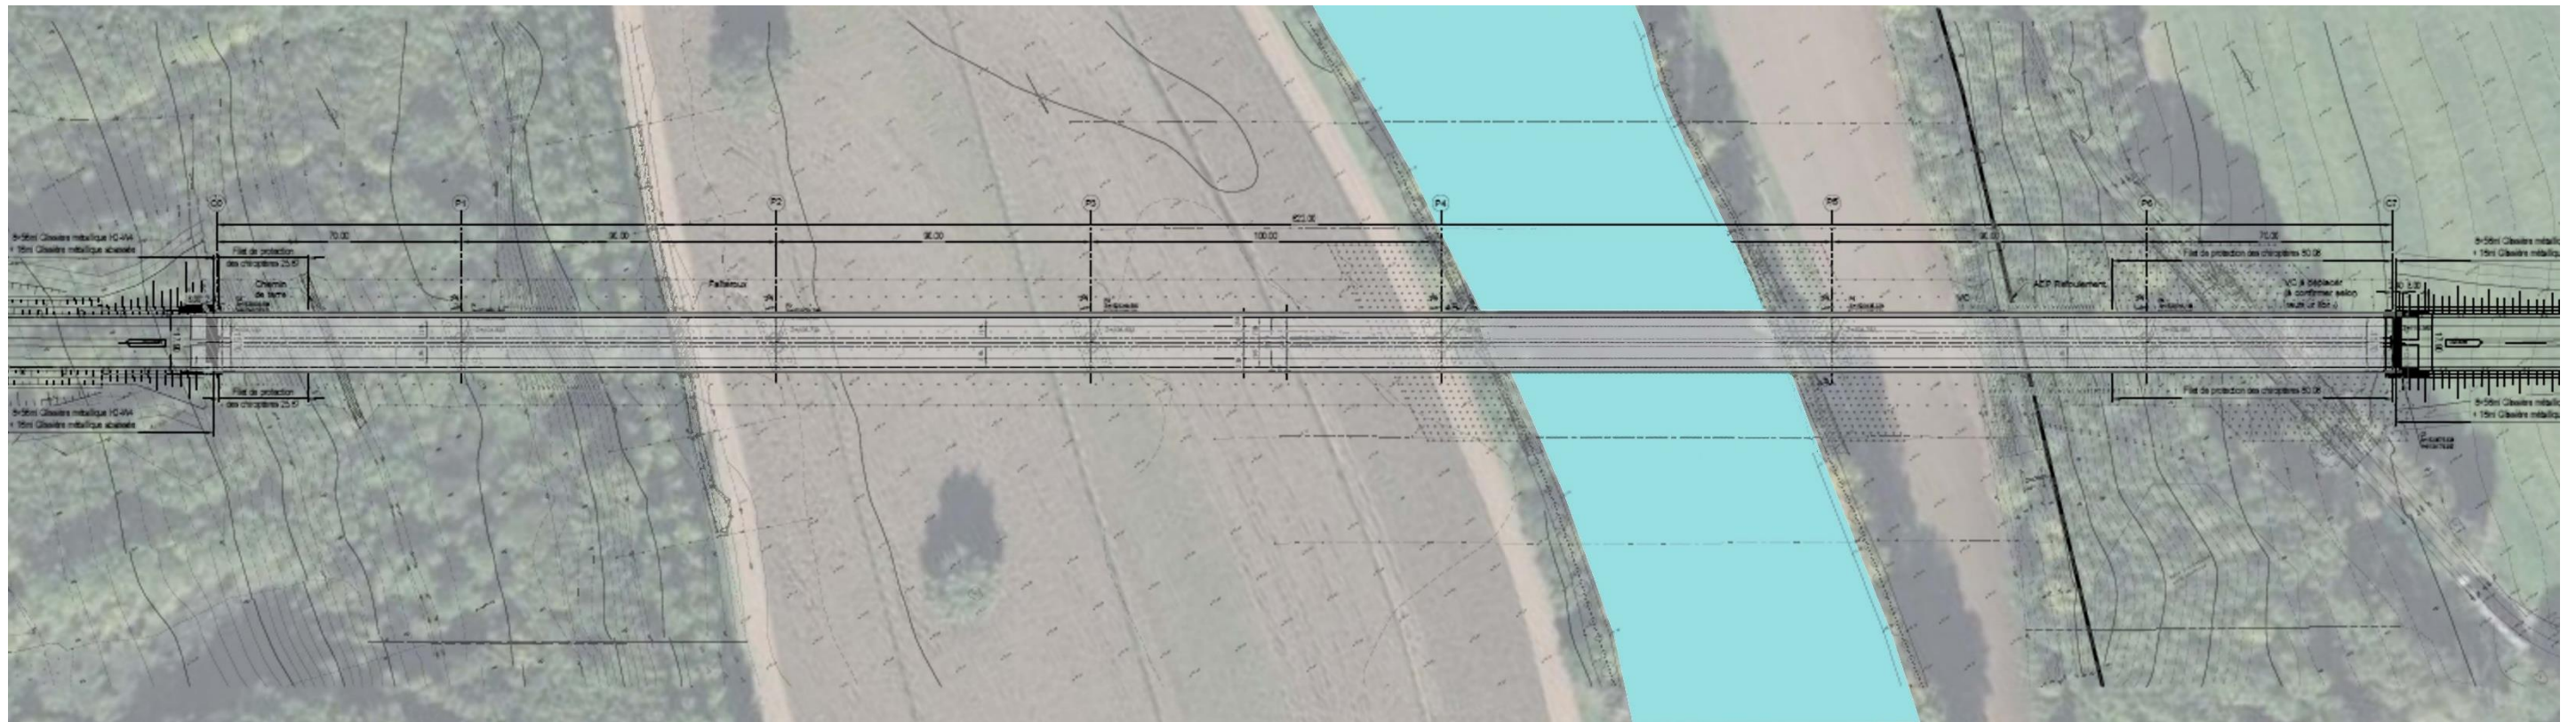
Vue en plan du viaduc de la Vienne, solution avec caisson
